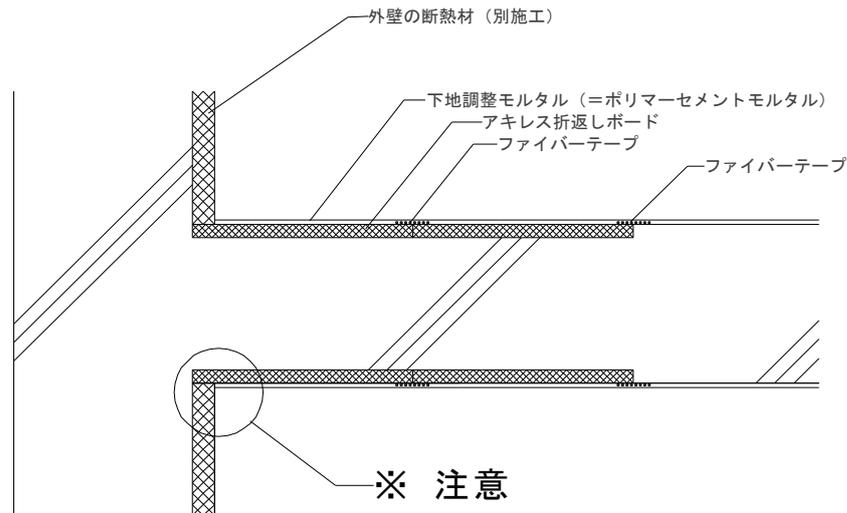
界壁の施工（目地部の処理と下地調整モルタル塗り）（平面図）
